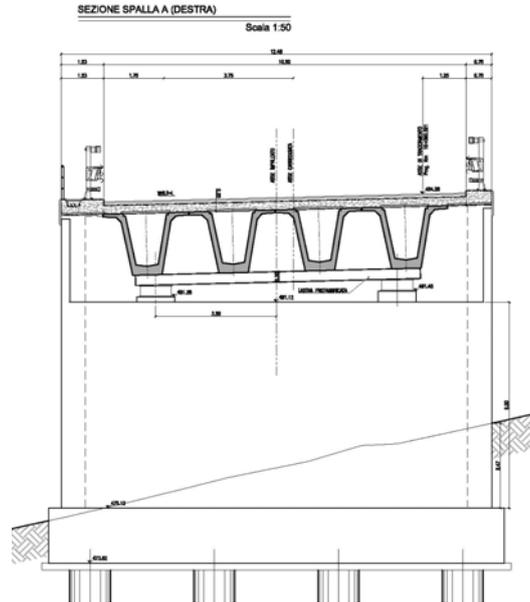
Sezione trasversale dell'impalcato in asse alla spalla A carreggiata DX
